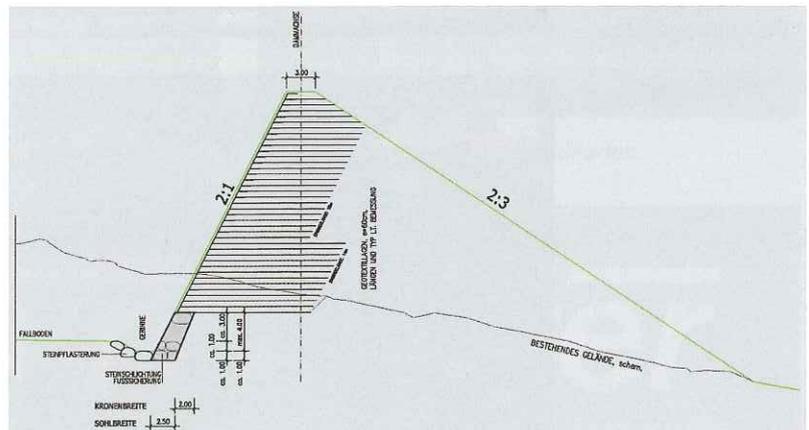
Hauptquerschnitt des Lawinenauffangdamms.
